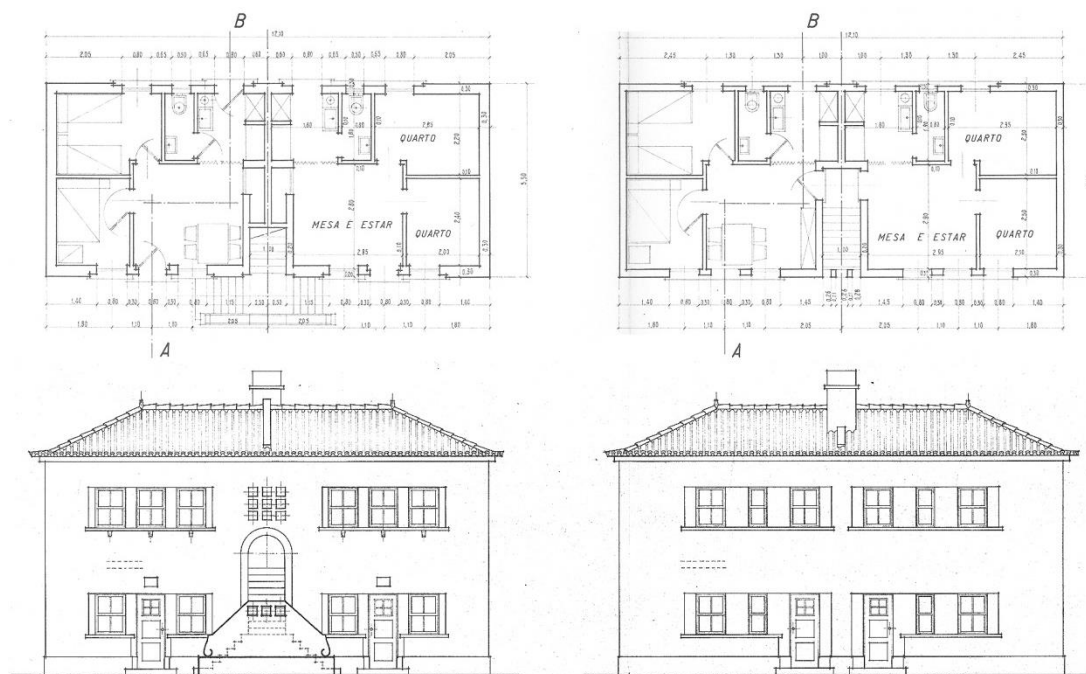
Plantas y alzados de las viviendas tipo B del barrio Alfonso Hurtado - antiguo barrio Carmona. (Fuente: Archivo del Sistema de Informação para o Património Arquitetónico - Arquivos Textuais Institucionais. Direção General del Patrimonio Cultural (DGPC). Ref.CE-0285).
